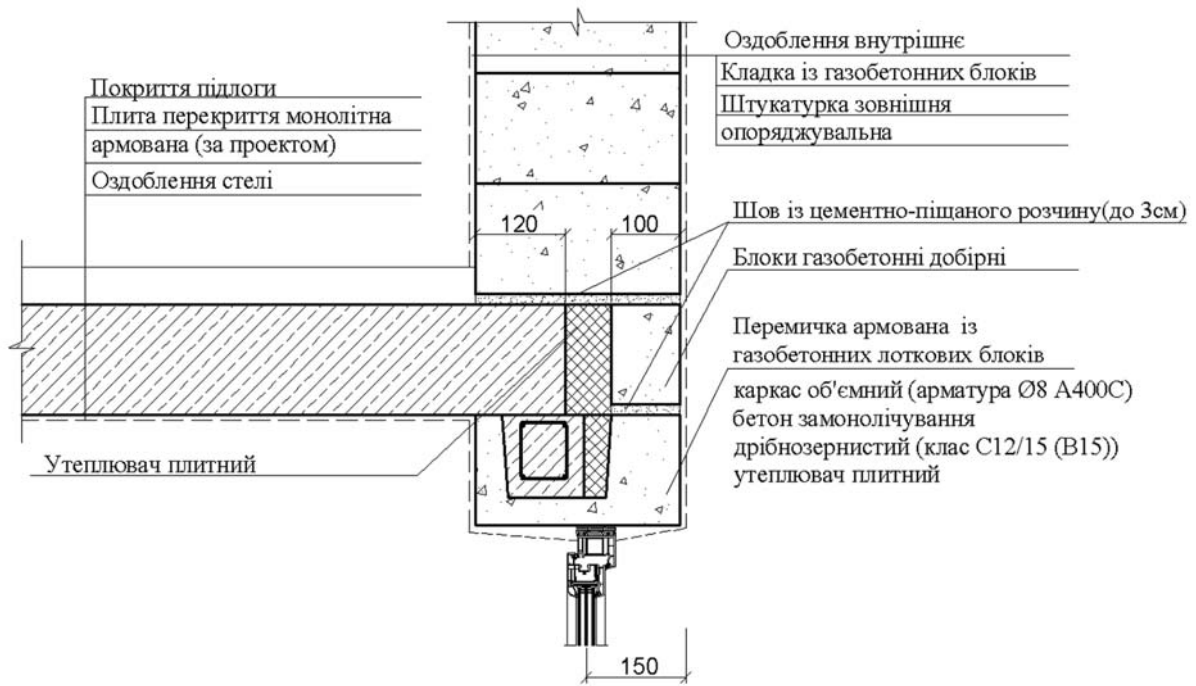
Вузол обпирання монолітного перекриття типового поверху на газобетонні стіни (світлопрозору частину)
